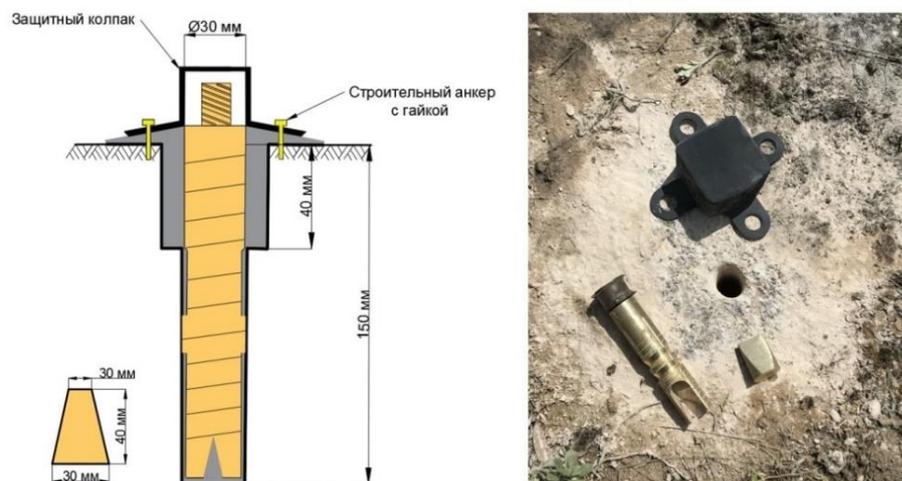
Схема и вид оптимальной конструкции скального центра
